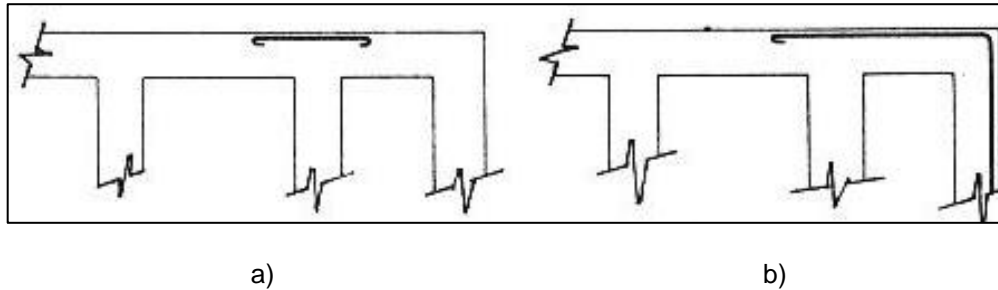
a) Armadura curta em disposição incorreta; b) Armadura prolongada em disposição correta. Fonte: (<<http://patologiaestrutura.vilabol.uol.com.br/causas.htm>> Acessado em 14/01/2012, às 11:45:24).
